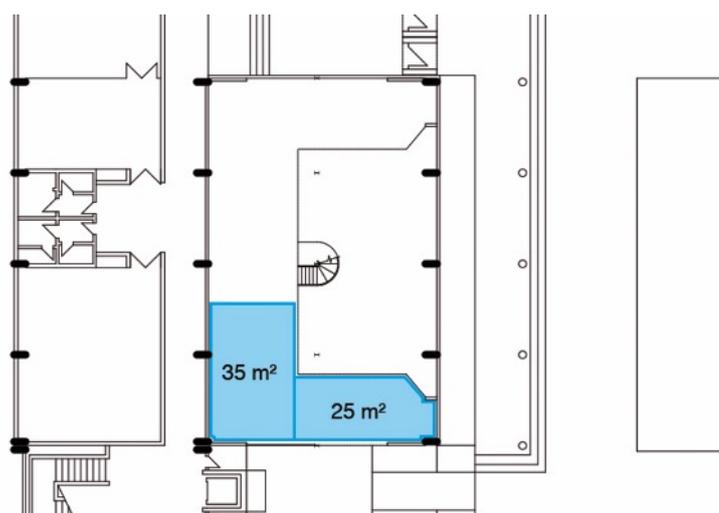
Plano planta alta aula de informática de libre acceso.
